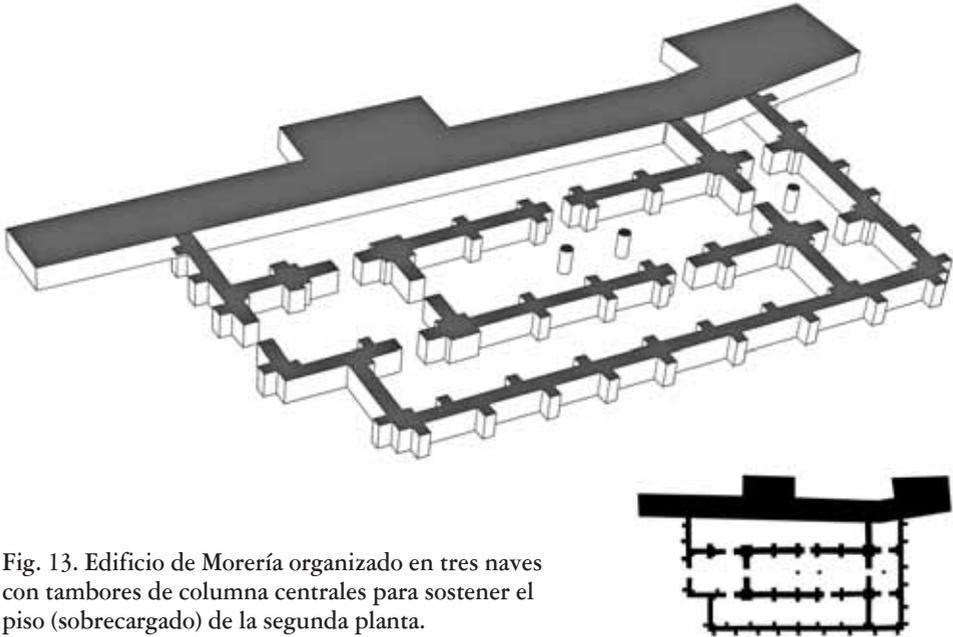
Edificio de Morería organizado en tres naves con tambores de columna centrales para sostener el piso (sobrecargado) de la segunda planta.
